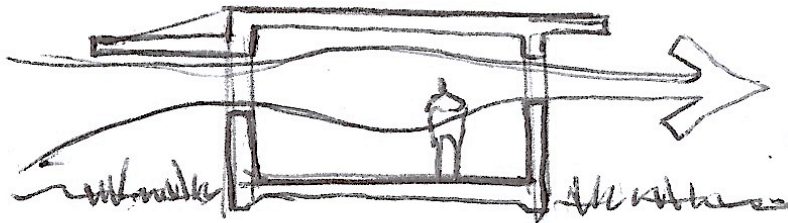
Voladizos fijos; la brisa sube y no alcanza.
